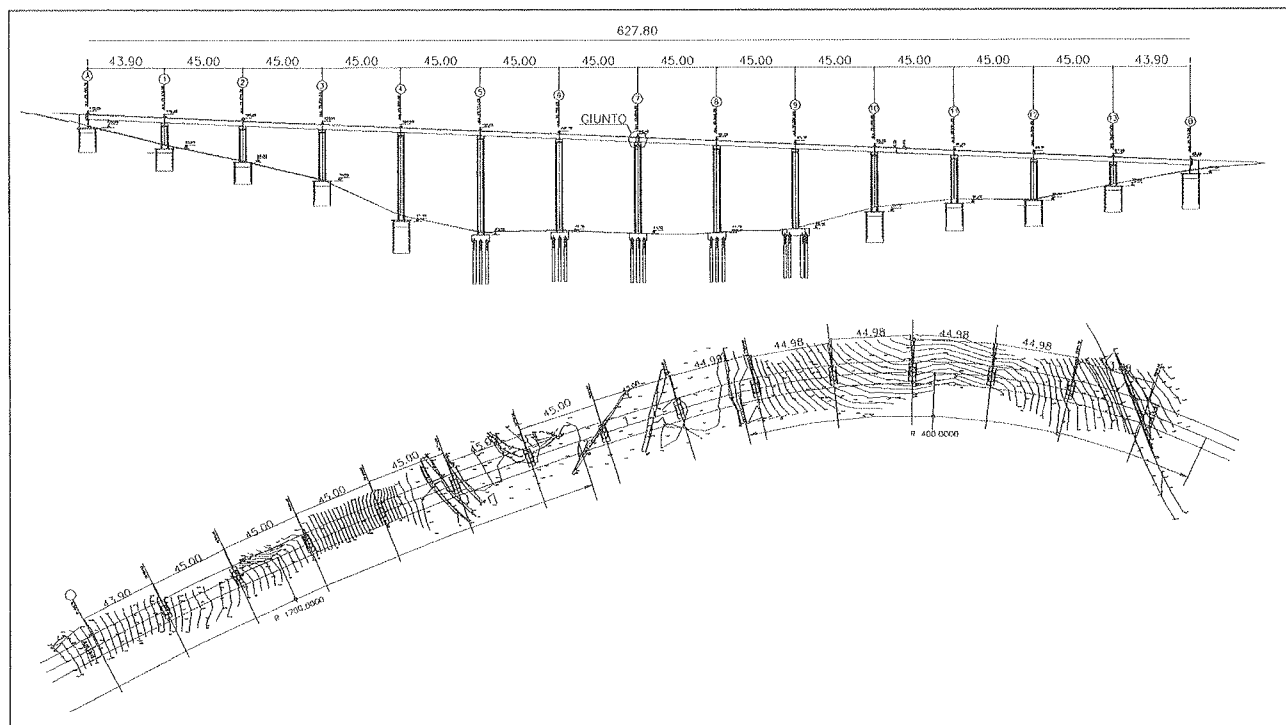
Planimetria e Profilo longitudinale Viadotto Serrapotamo
